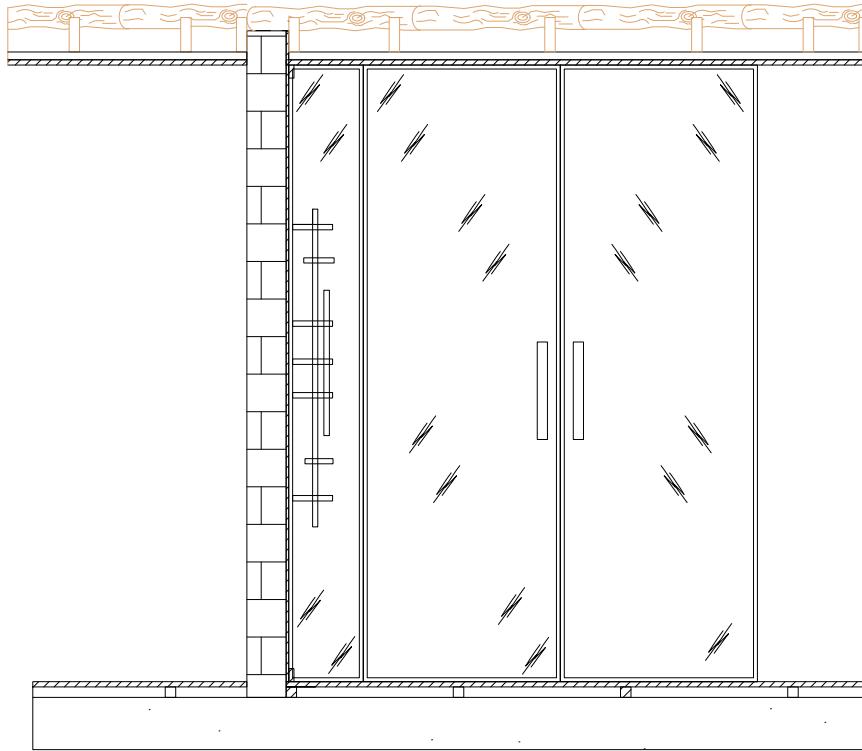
Sección puertas de vidrio. Romero, (2018).
